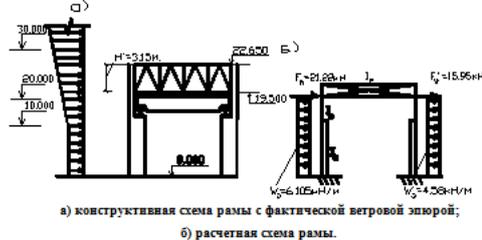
К определению ветровых нагрузок (нагружение № 3)
